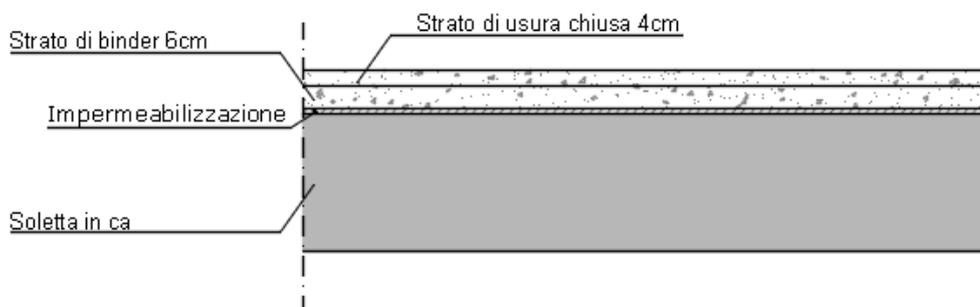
Composizione sovrastruttura rampe svincolo di Dalmine su impalcato – TIPO P1B
